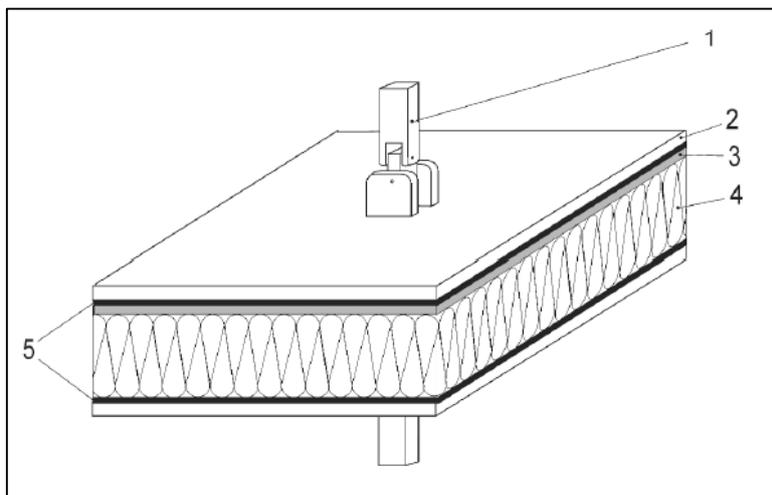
1-Dispositivo per il montaggio centrale delle piastre rigide 2-Piastra rigida 3-Rasante armato 4-Pannello isolante 5-Colla. Fonte: UNI EN 13494:2002
